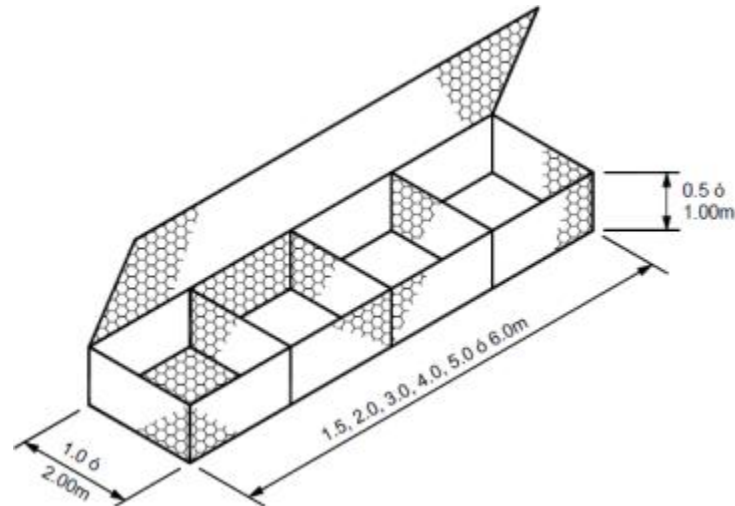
Ancho de Cimentaciones para Hilada de Gaviones
